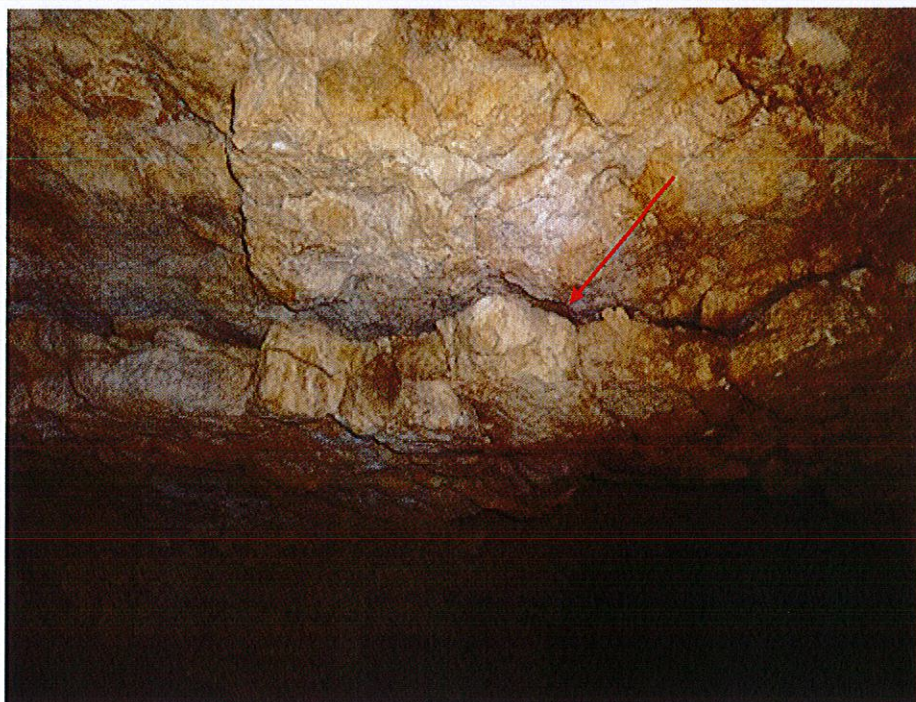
écaille partiellement désolidarisée, au toit de la cavité du site 2.
